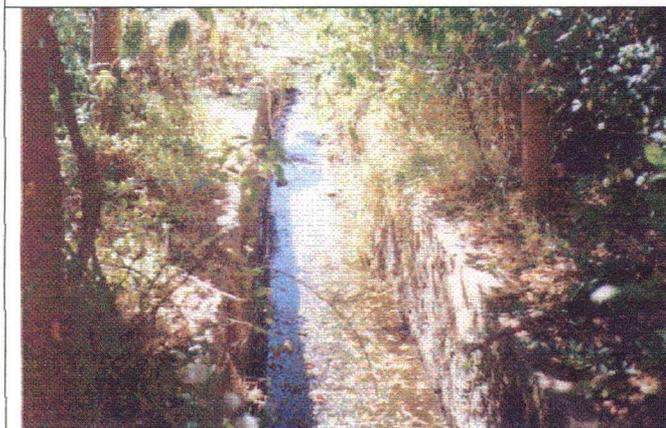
Tramo 4 Revestido. Revestimiento con mampostería de piedra.
